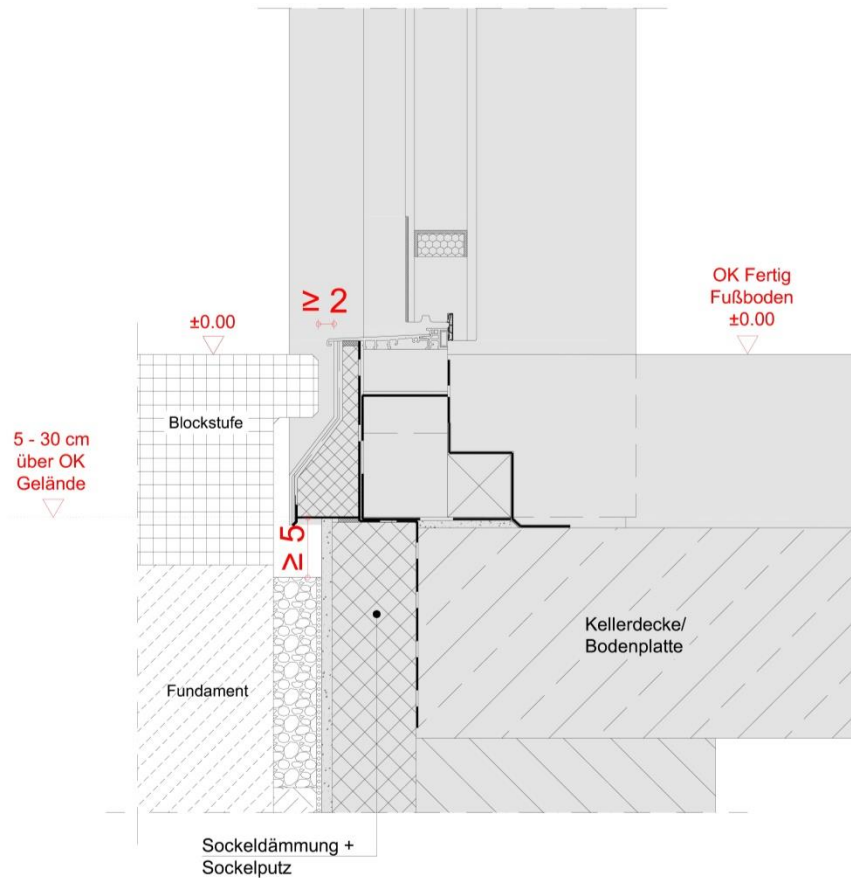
LUXHAUS Sockeldetail 12 - Hauseingang mit Blockstufe
